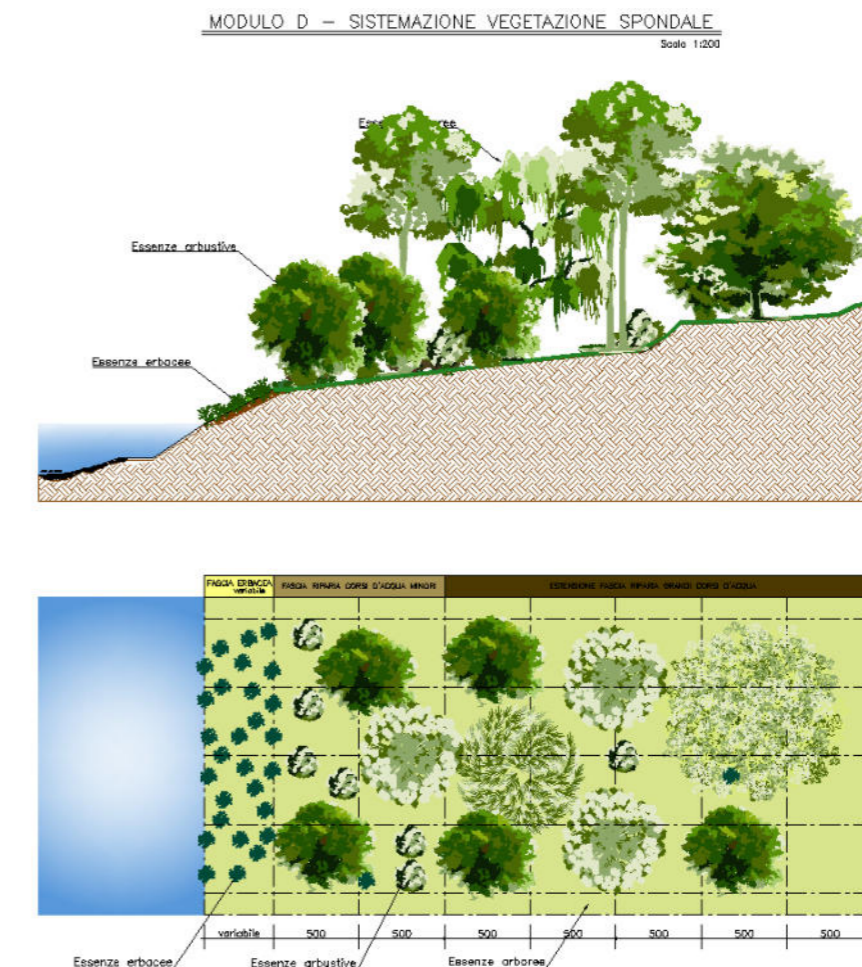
MODULO D – Sistemazione vegetazione spondale: sesto d'impianto e sezione tipologica
